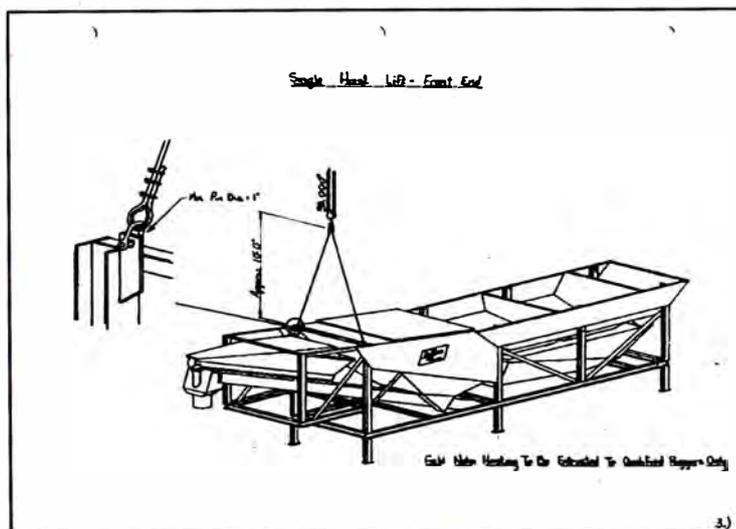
Maniobras de izaje planta CONE-CO LO PRO 10 (Fuente: CON-E-CO)
